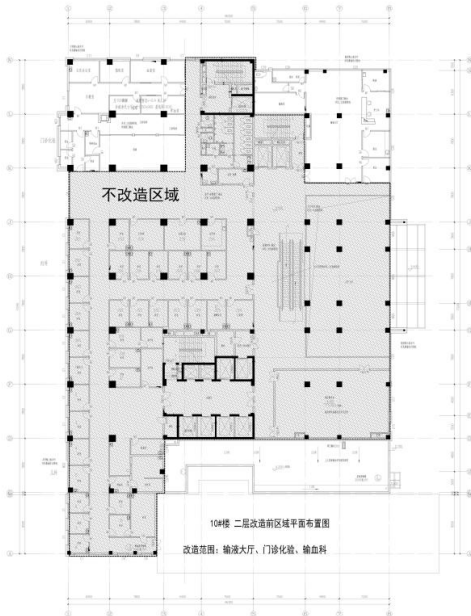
10 号楼 2 层改造前平面图 图 5-12 10 号楼 2 层改造后平面图
